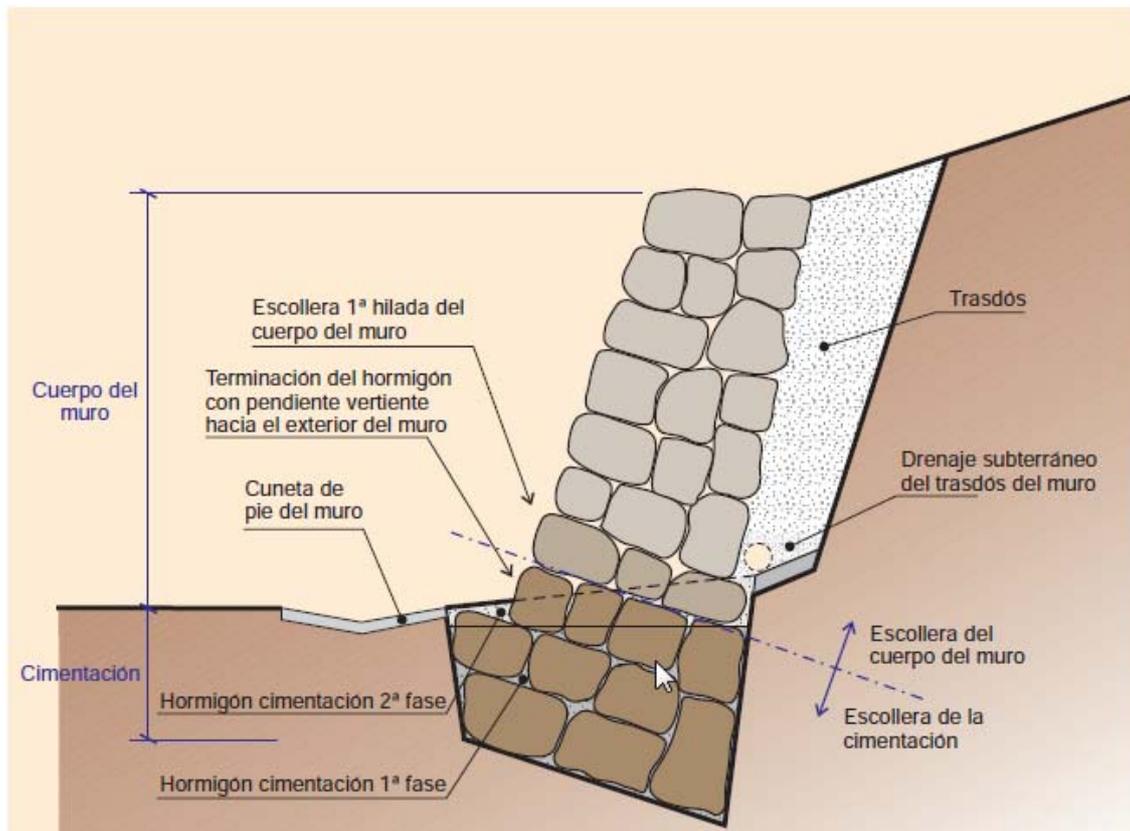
PARTES DE UN MURO DE ESCOLLERA.
